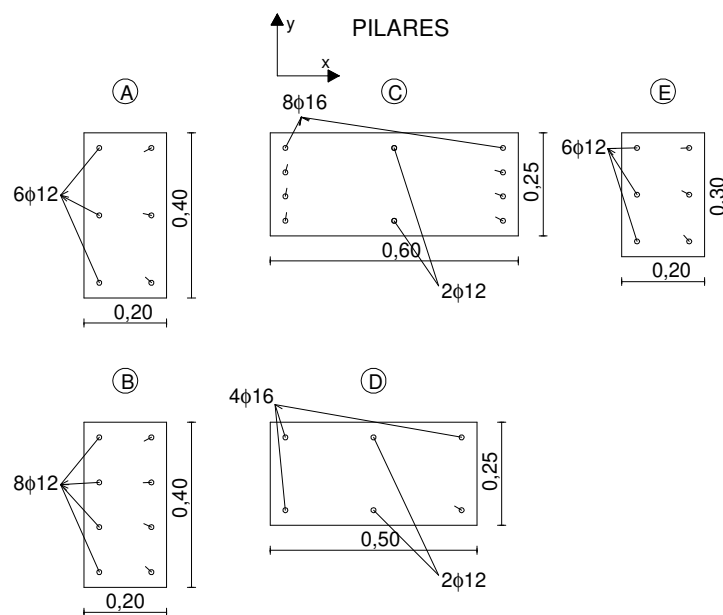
Secções dos pilares do pórtico de 4 pisos
